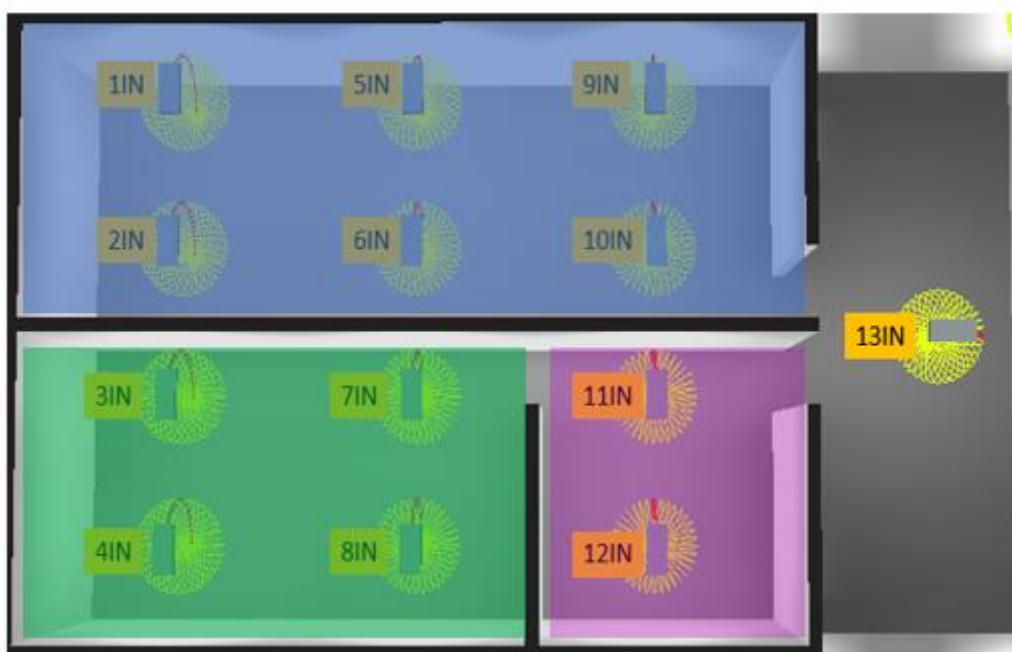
Distribución de Flow LED- BGP490 LLM3200/840 I DTS 9007 (luminarias interiores) – vista planta
